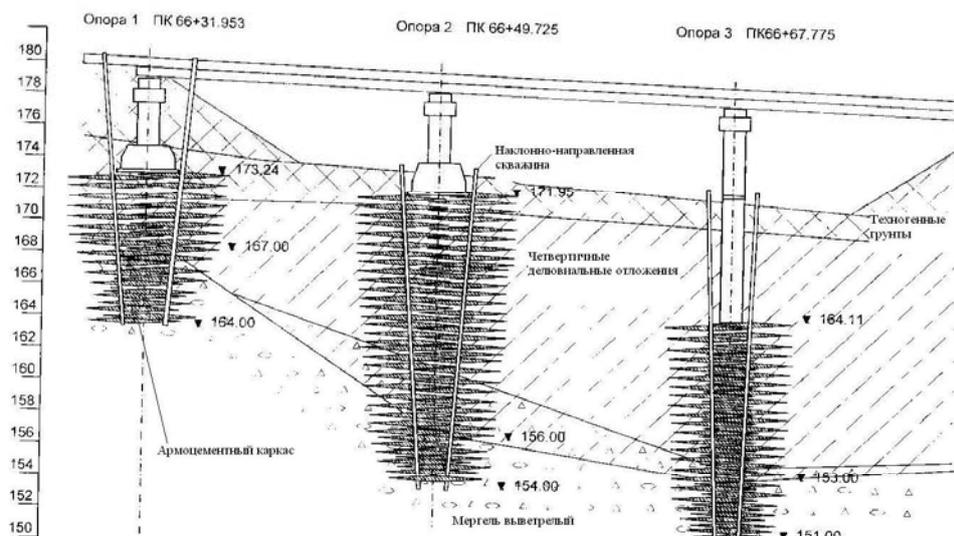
Расположение опор путепровода на ПК 66+58,61 автодороги Киев-Луганск-Изварно со схемой укрепления грунтов через наклонно-направленные скважины
